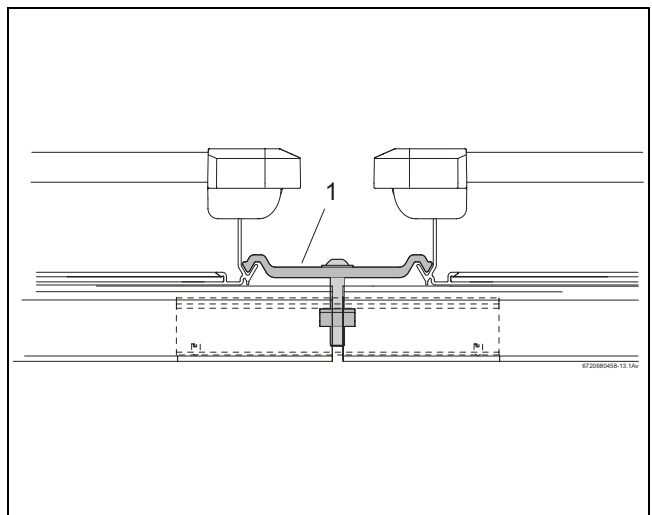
Двосторонній натяжний пристрій для колектора між двома колекторами
